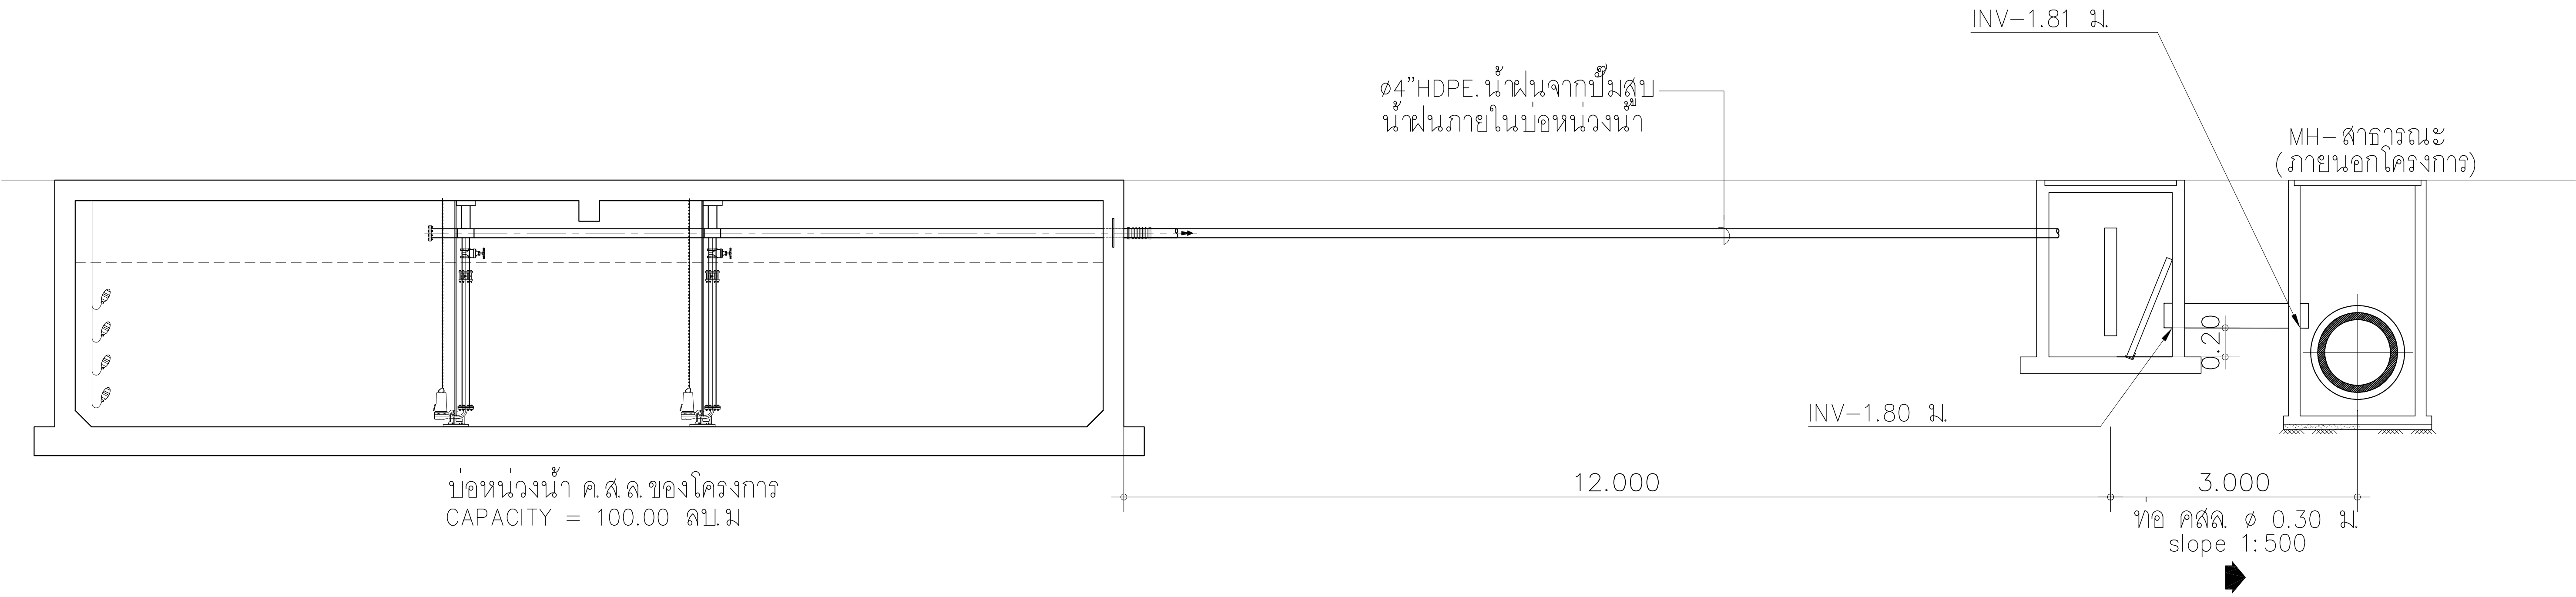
แบบแปลนและรูปตัดบ่อหน่วงน้ำภายในโครงการ (ต่อ 1)
